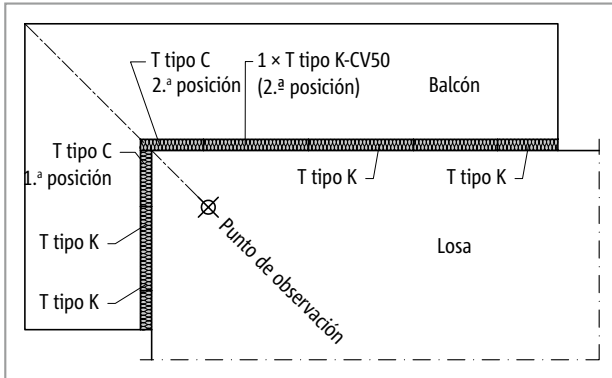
Schöck Isokorb® T tipo C: Balcón en voladizo con esquinero externo
